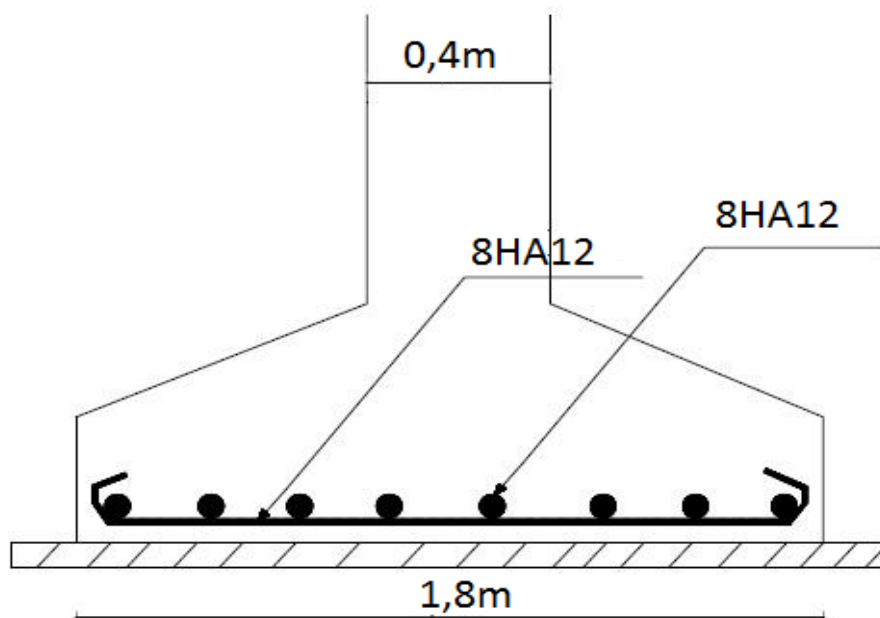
Schéma de ferrailage de la semelle type 2.
